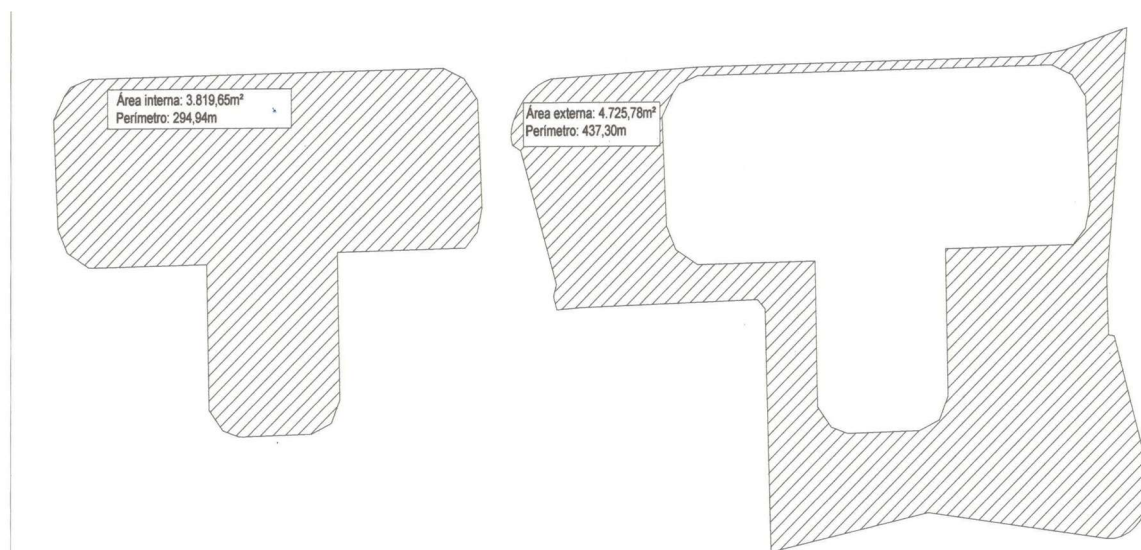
Planta de dimensionamento interno do mercado de Taubaté
